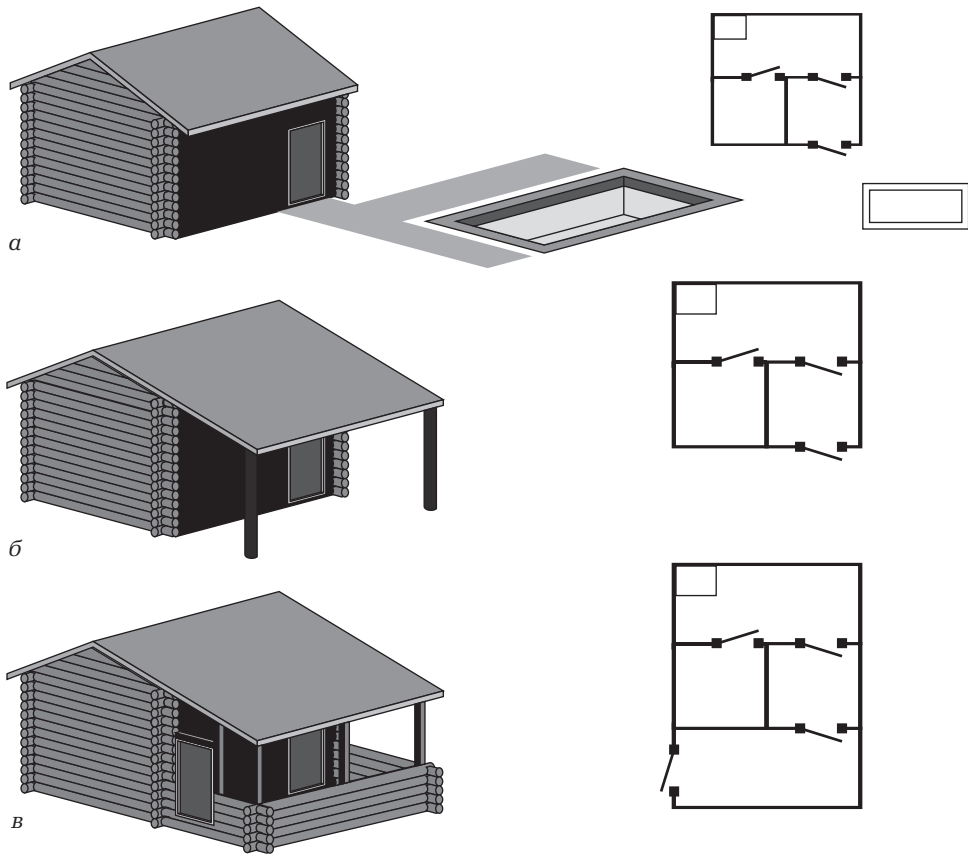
Фасады и планы отдельно стоящих саун с возможностью отдыха на открытом воздухе: а — сауна для двух человек у бассейна или пруда; б — сауна для двух человек с открытым крыльцом; в — сауна для 4–6 человек с закрытой верандой
